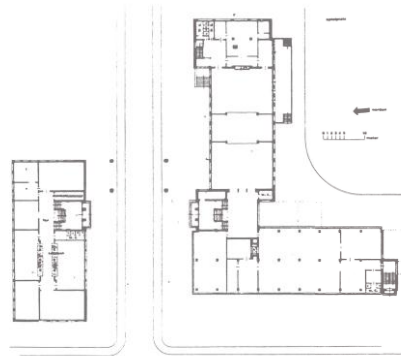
Planta Baja Edificio de la Bauhaus (Duque, 2014)
